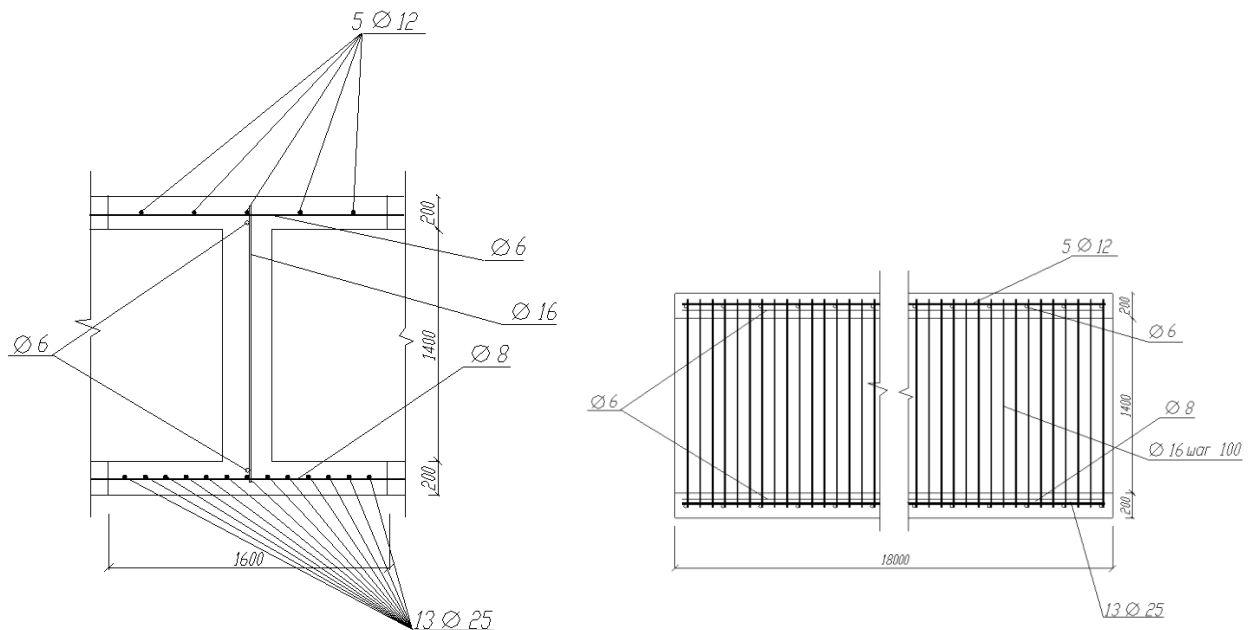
Схема армування фундаменту на ділянці між осями Г – Ж.
